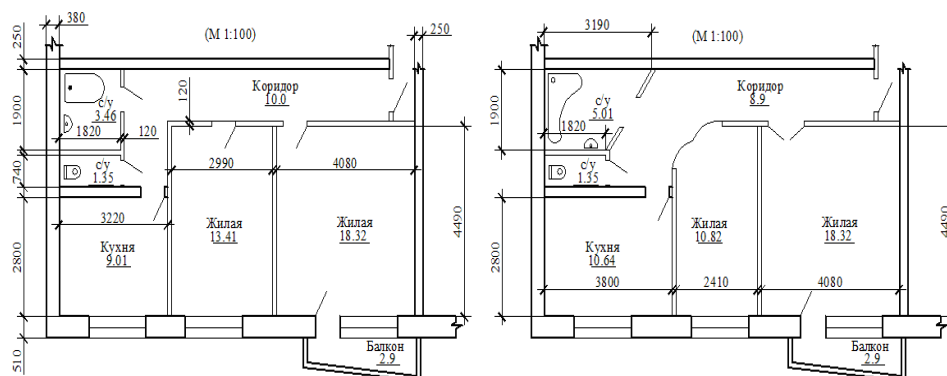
Вариант перепланировки двухкомнатной квартиры
